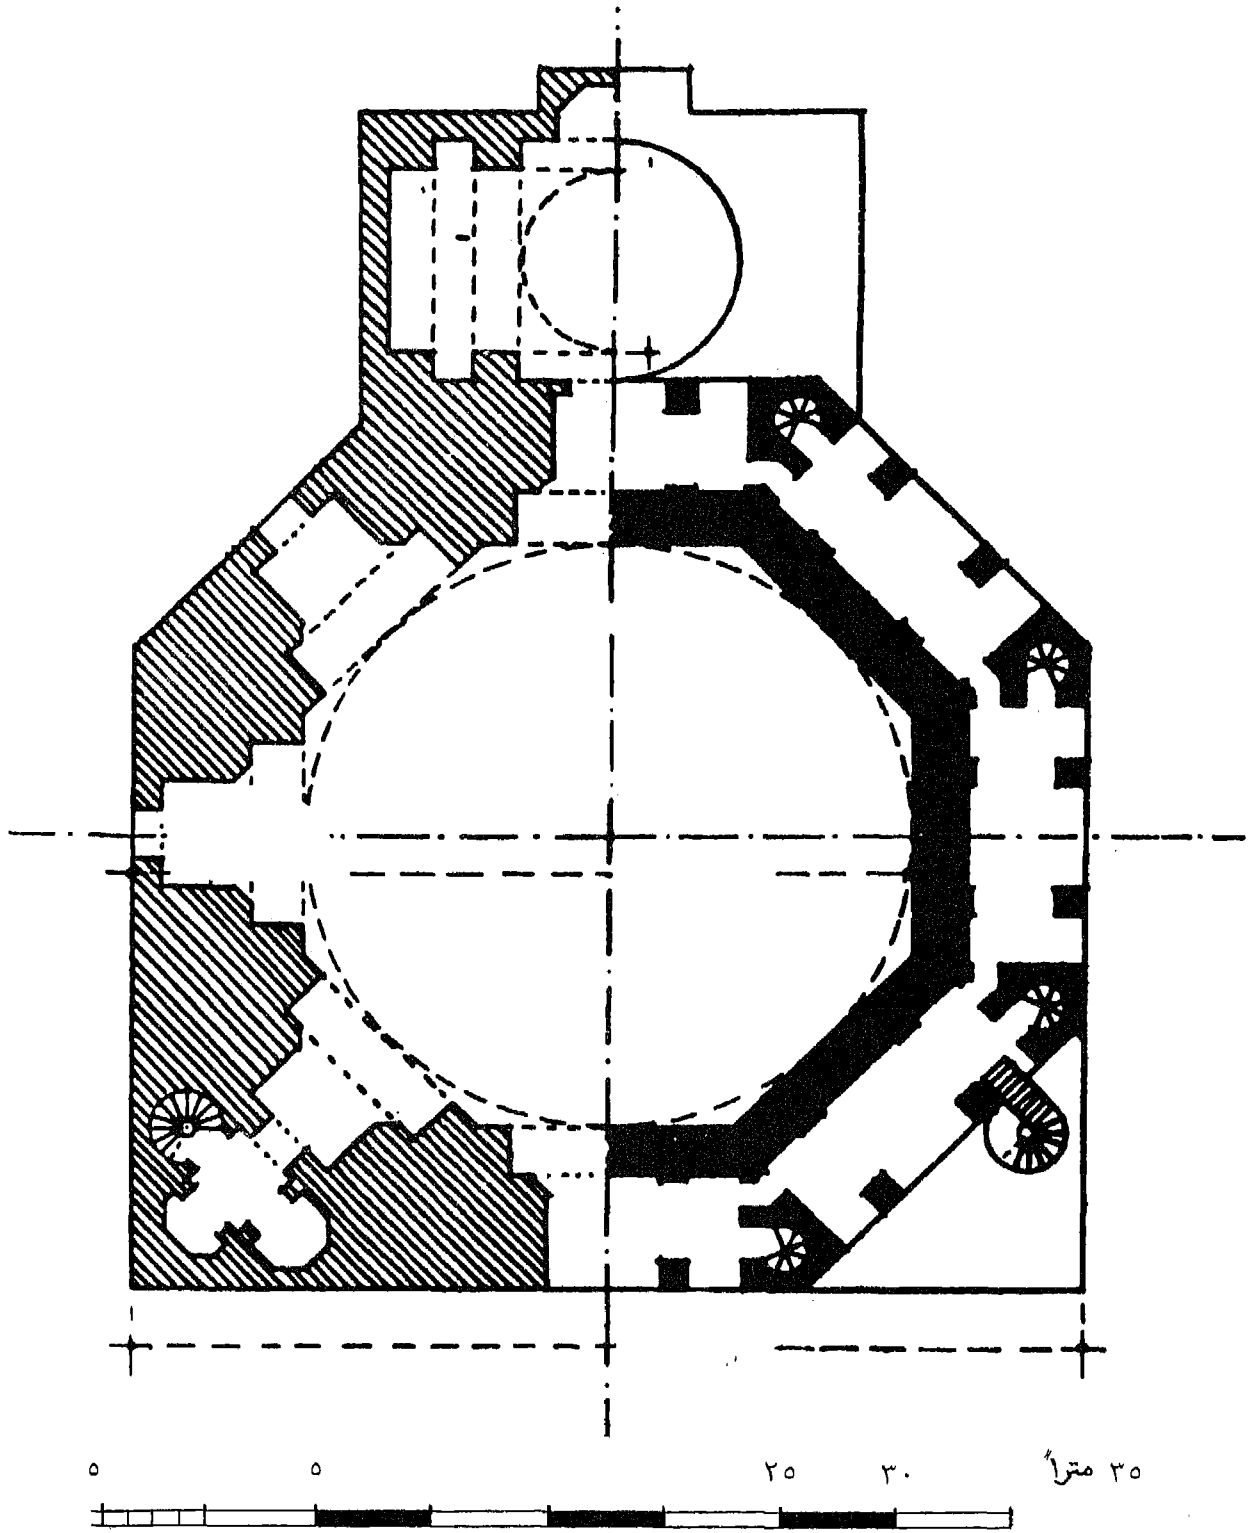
مسقط أفقى للطابق الأول من المدرسة المستنصرية.. [بيان من مديرية الآثار العامة بالعراق]
